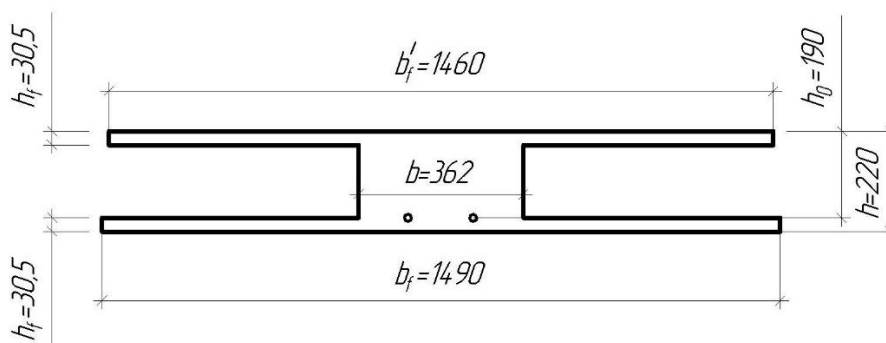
Расчетное сечение железобетонной плиты перекрытия
